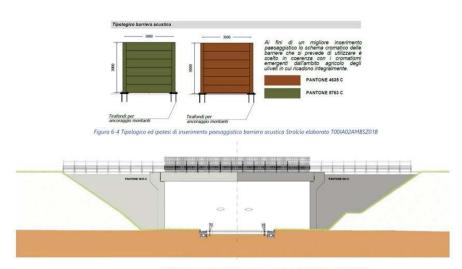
Prospetto cavalcavia n. 2 - tratto 5
